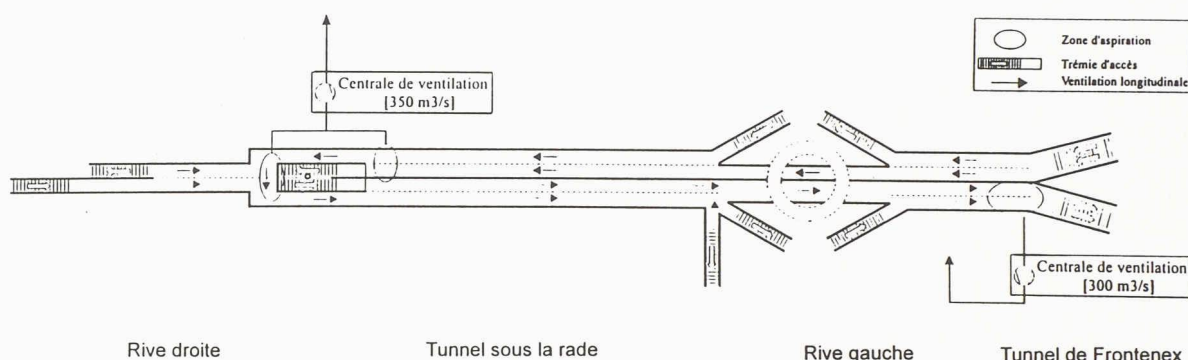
Tunnel sous la rade et tunnel de Frontenex : schéma de ventilation
